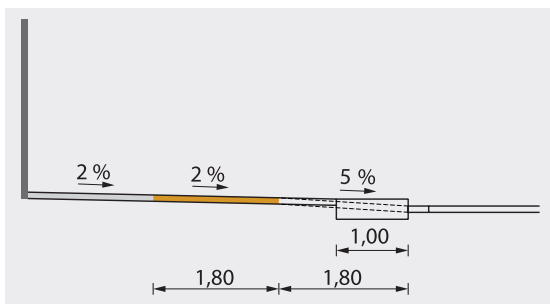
Piste cyclable séparée au niveau d'une traversée piétonne, coupe transversale.
